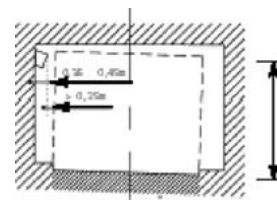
Perfil cuadrado instalación bilateral
